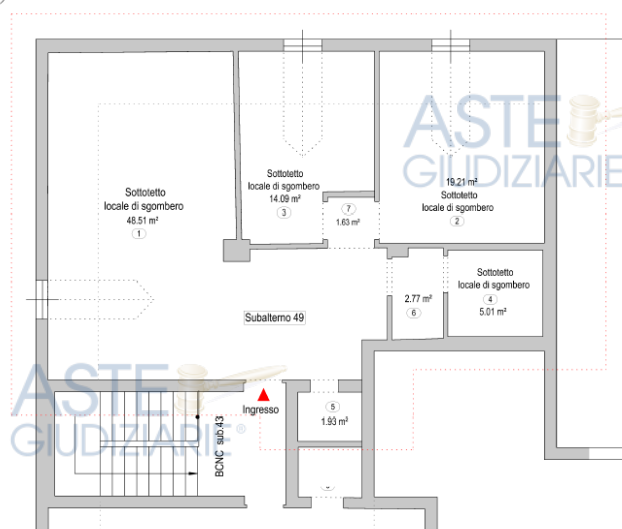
Planimetria subalterno n.49 (piano secondo). Si rimanda all'Allegato A per elaborato in scala
